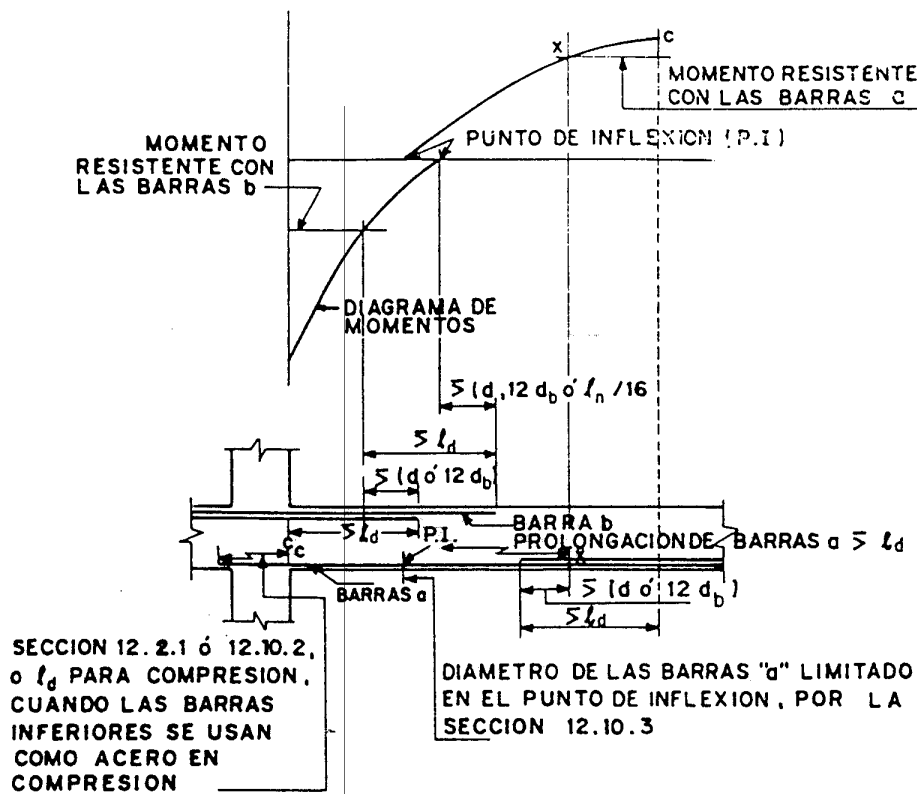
DESARROLLO DE LAS ARMADURAS DE FLEXION EN UNA VIGA CONTINUA TIPICA
